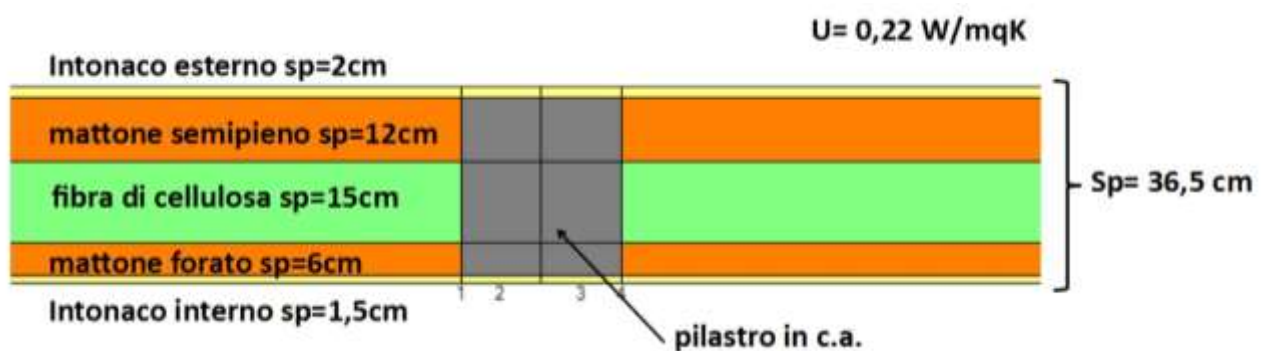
Nodo muro a cassa vuota – pilastro stato isolato
